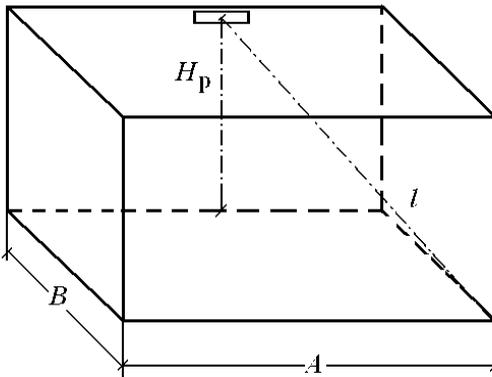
Расчетная схема установки УФ-обеззараживания воздуха помещения без принудительной системы вентиляции
